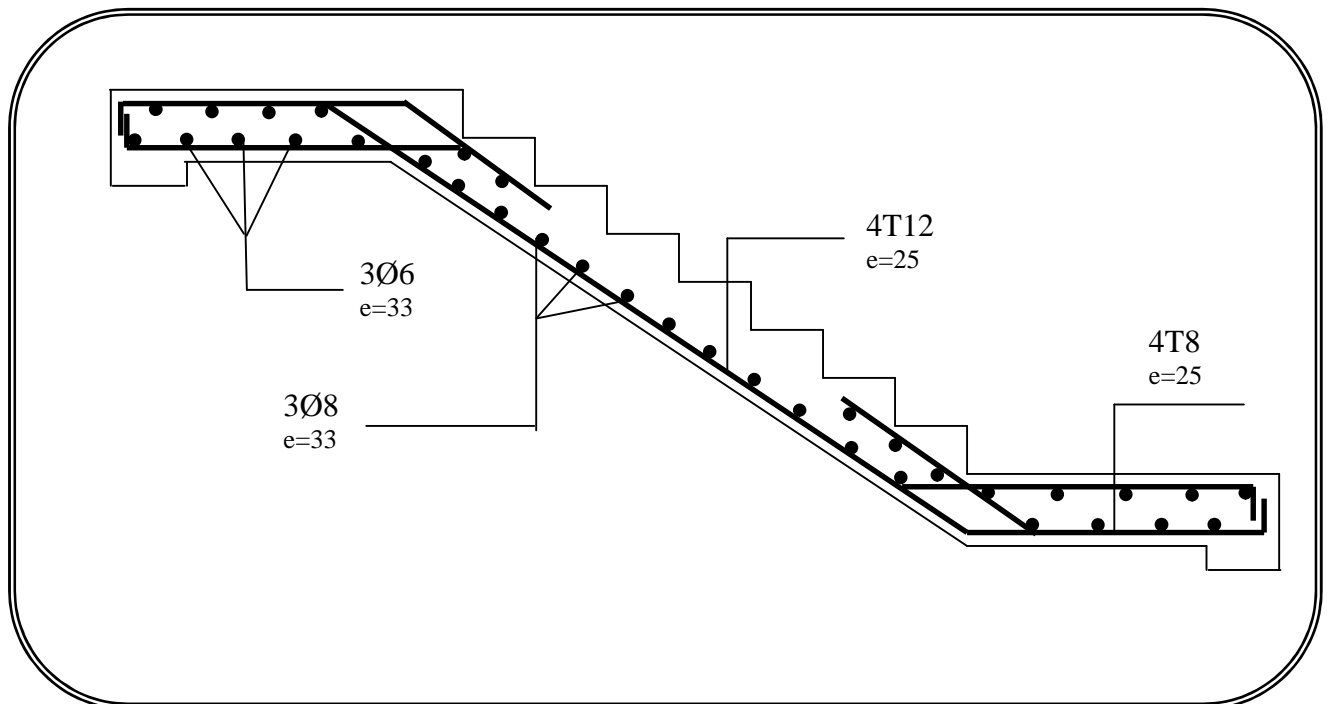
ferrailage de l'escalier (volée I-II)
